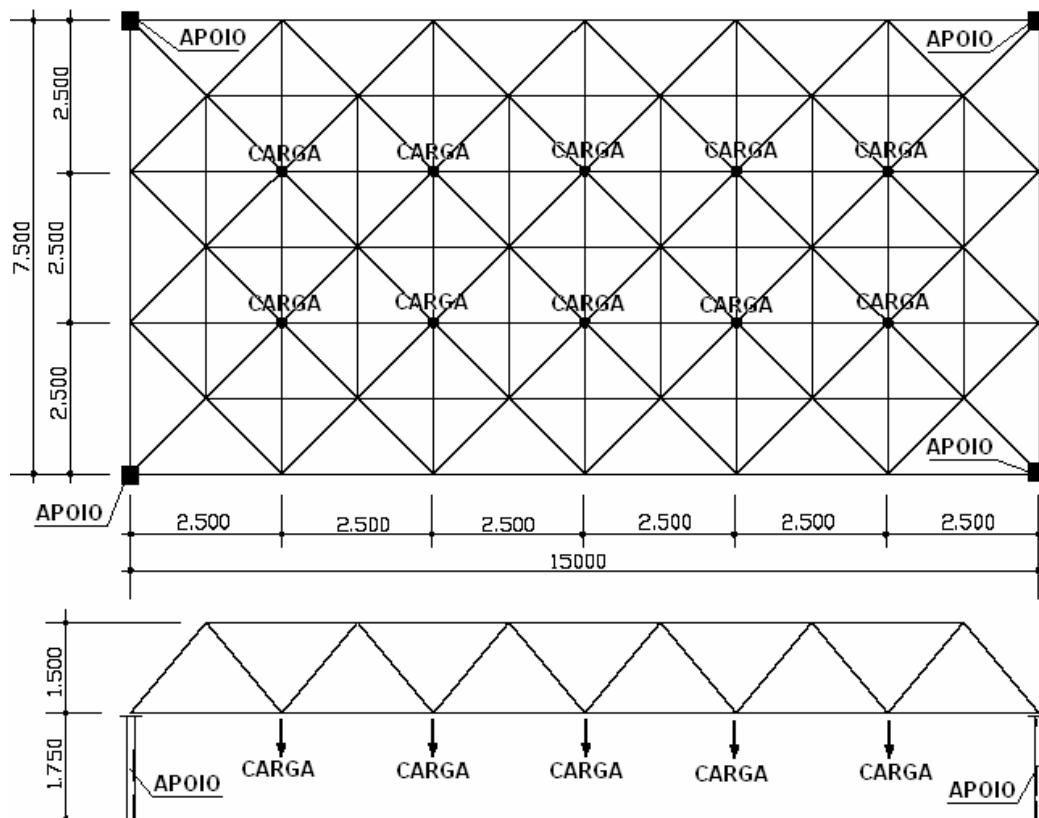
Protótipo com dimensões em planta de 7,5x15,0m (Souza, 2003)
